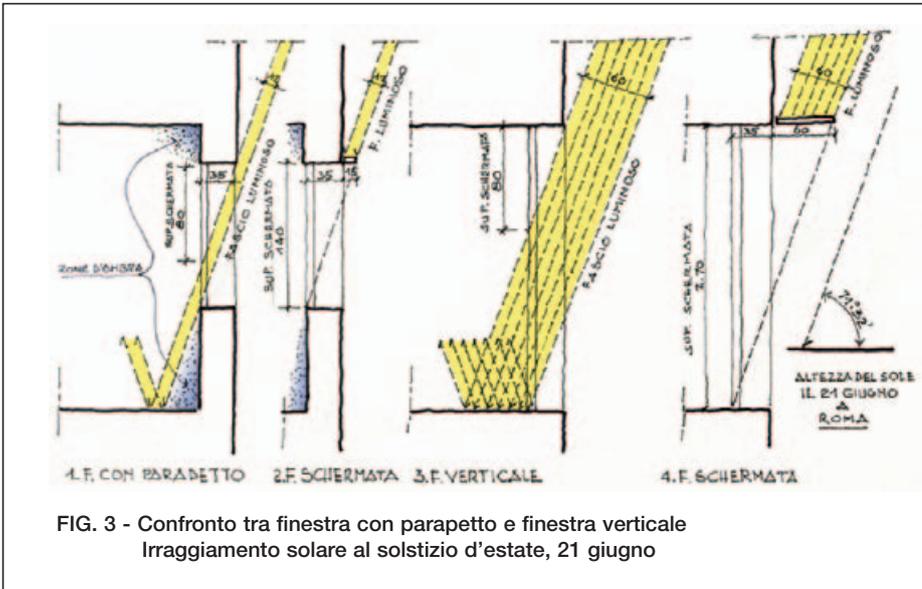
Confronto tra finestra con parapetto e finestra verticale
